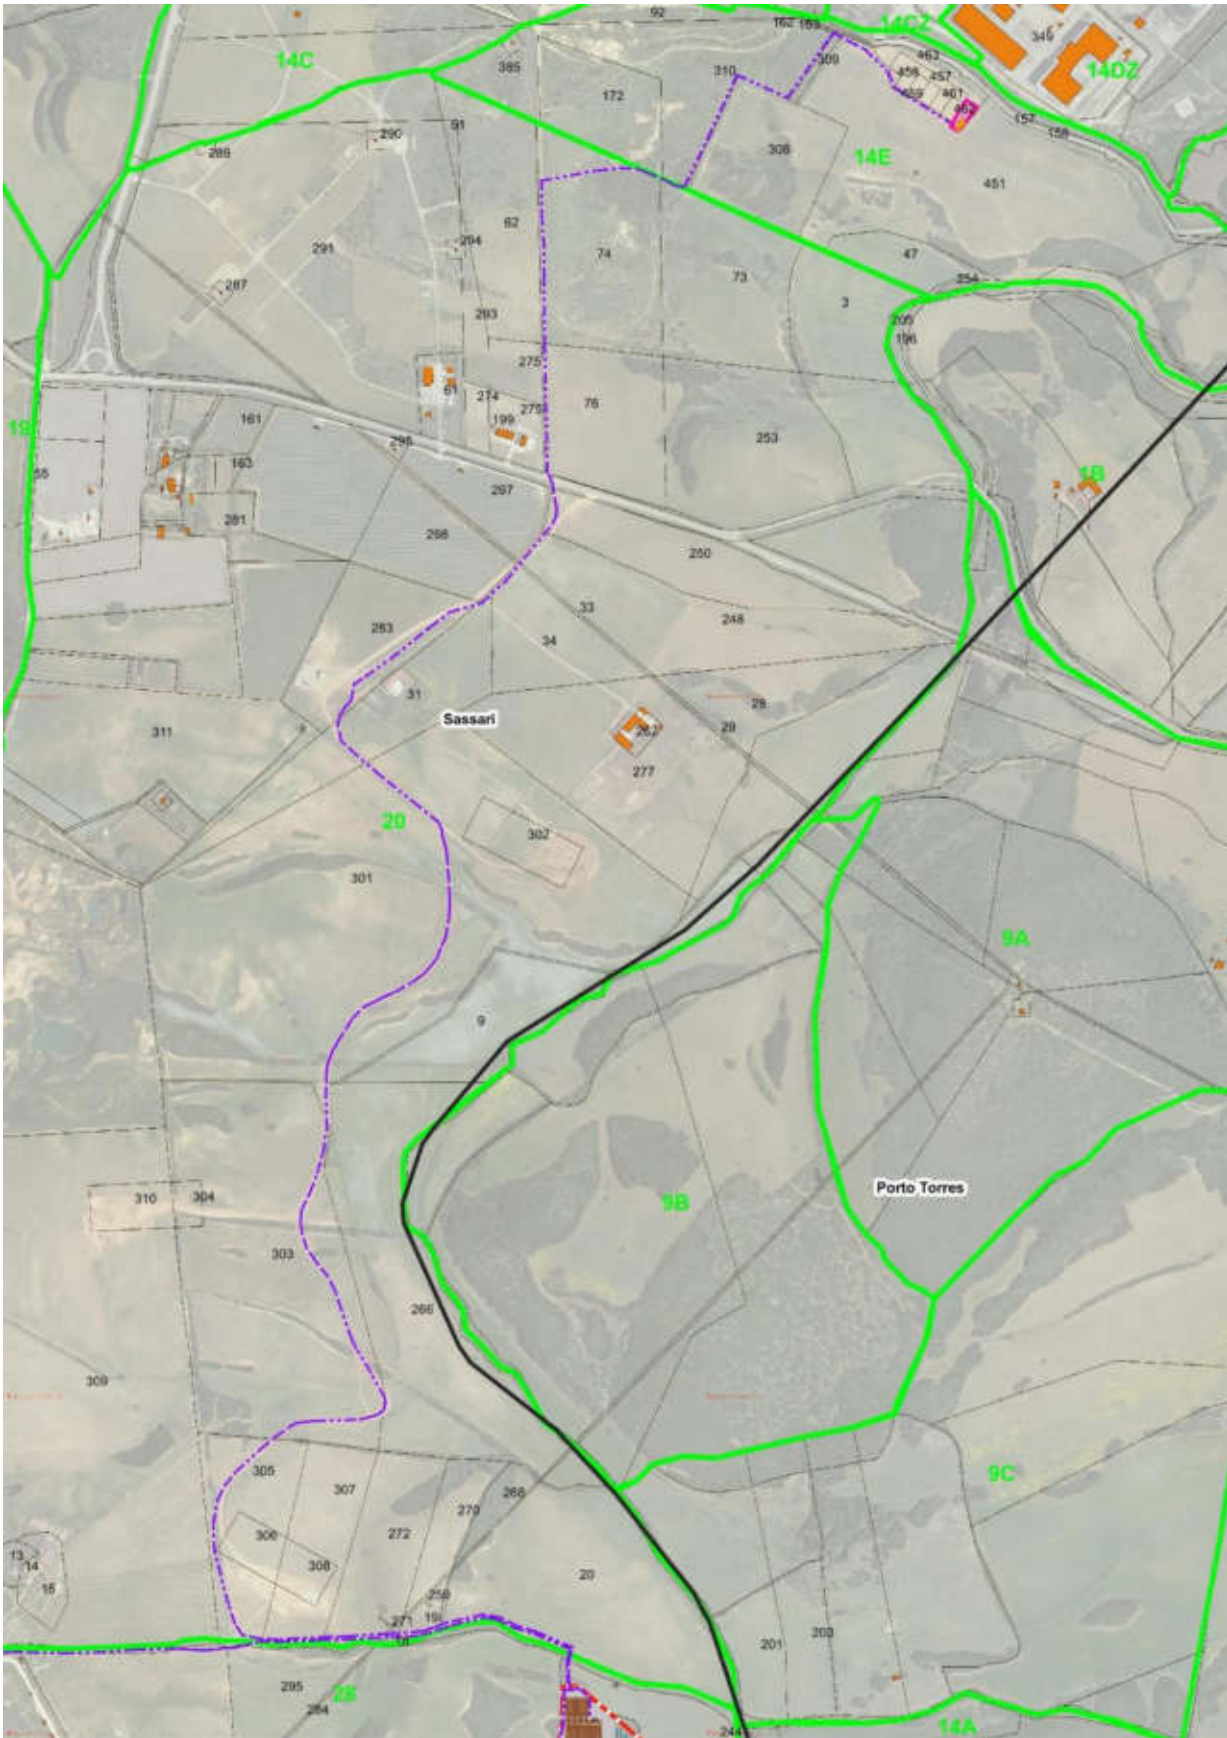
Stralcio planimetria catastale del cavidotto e del punto di connessione
